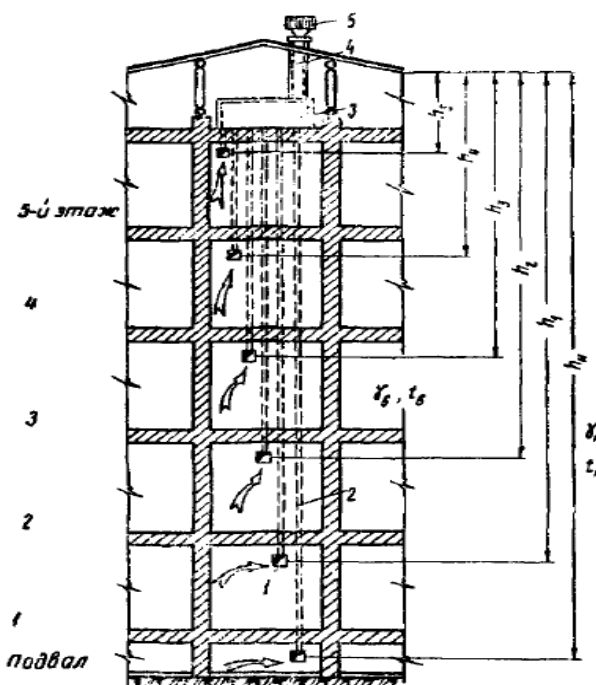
Схема естественной вентиляции помещений 5 – этажного дома под действием теплового напора:
